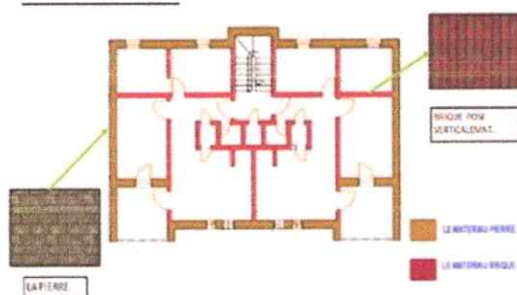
plan d'un appartement avec mur porteurs en pierre et murs de séparation en brique
